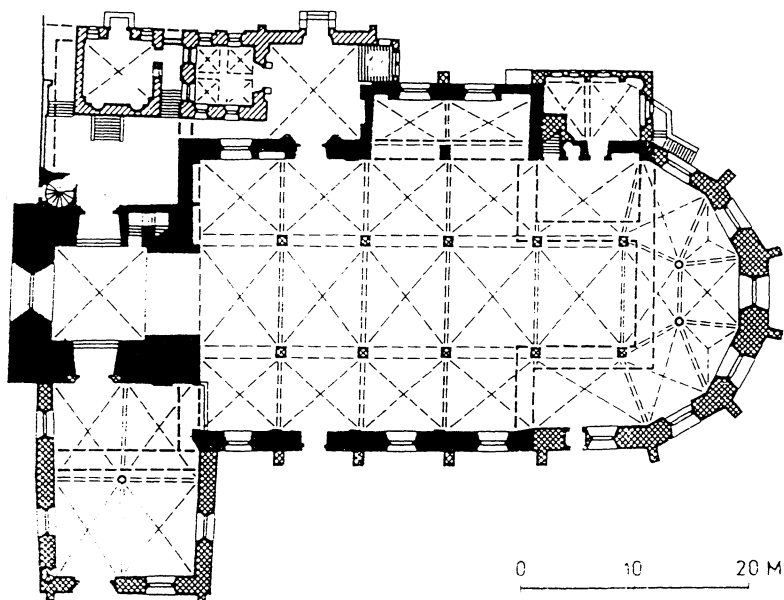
Reval (estn. Tallinn): Grundriss der Nikolaikirche
